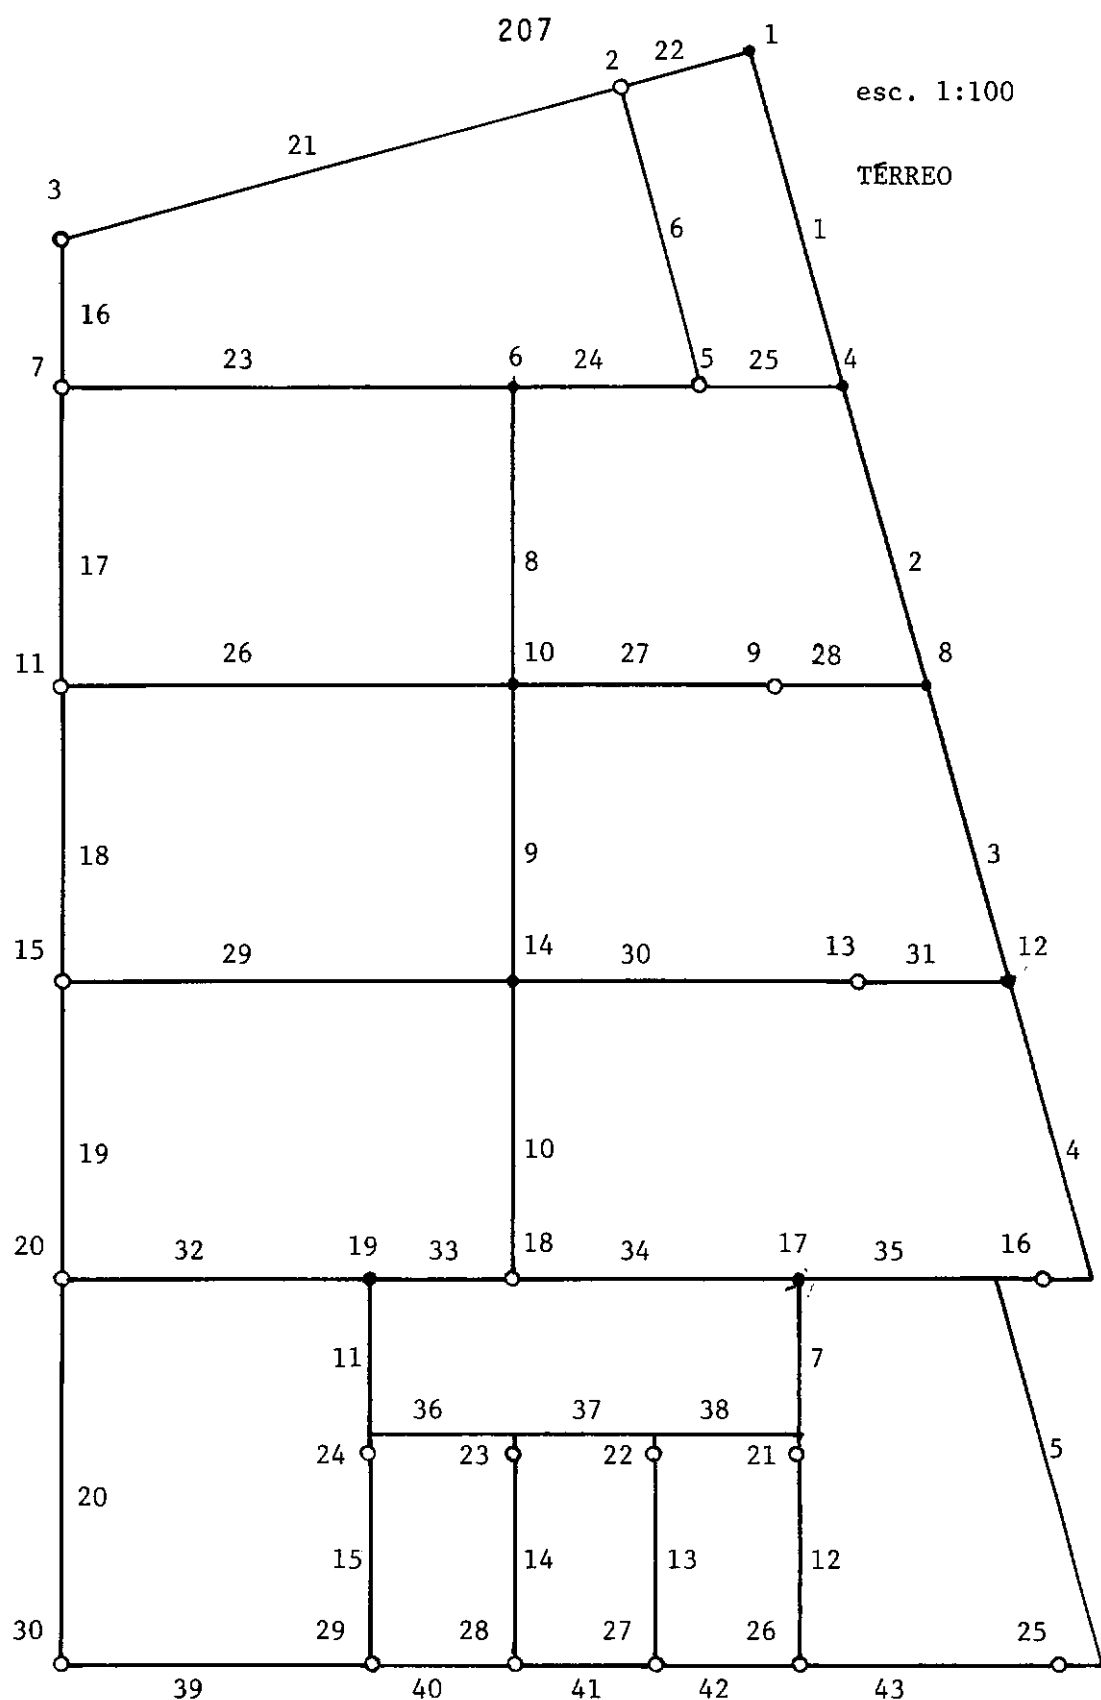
Planta de Locação dos Pontos Nodais.
